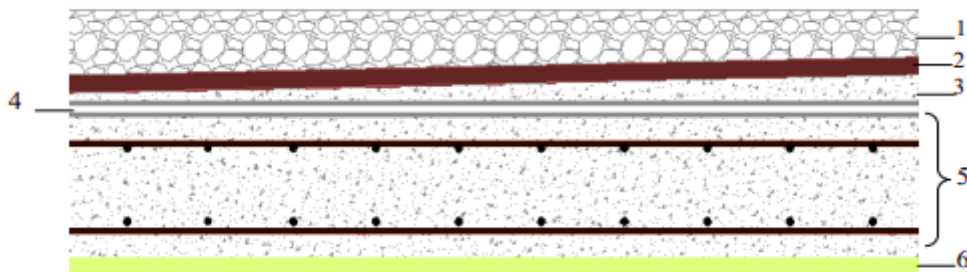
Composants d'un plancher terrasse en dalle pleine.
